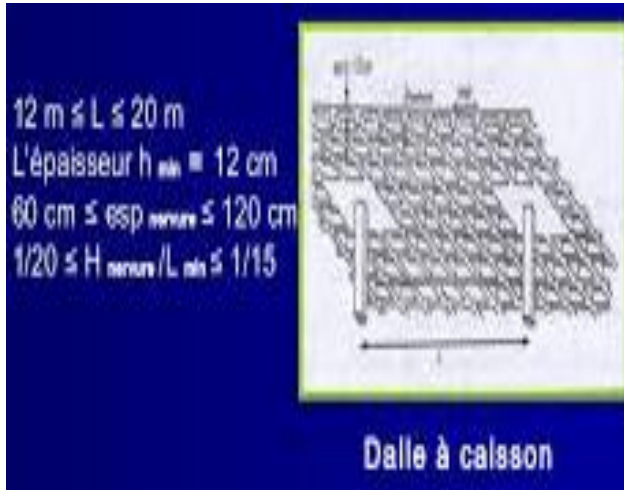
Photo montre détail dimensionnel du plancher à caisson    Figure79 : photo montre les détails du plancher à caisson
